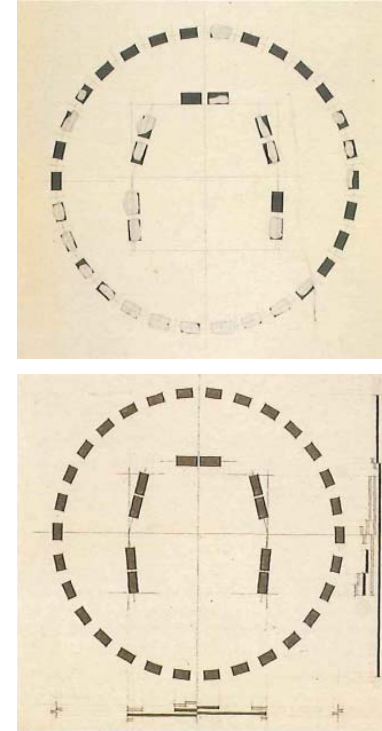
Schema planimetrico dell'esistente e ipotetico di Stonehenge
